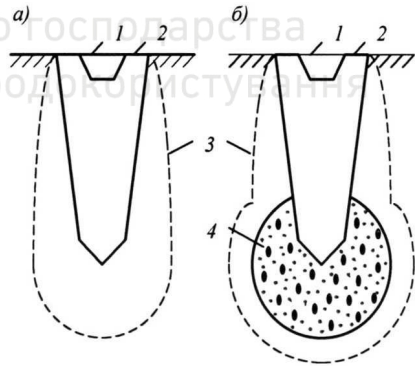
Фундаменти у витрамбованих котлованах:
